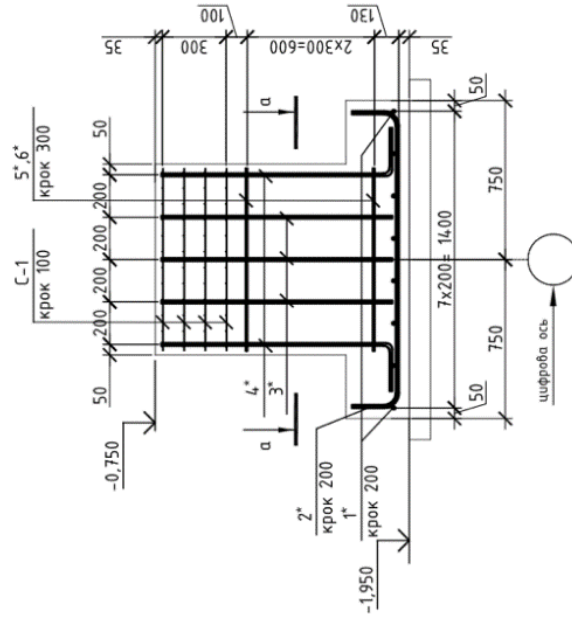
Вузол влаштування фундаменту ФМ-2
